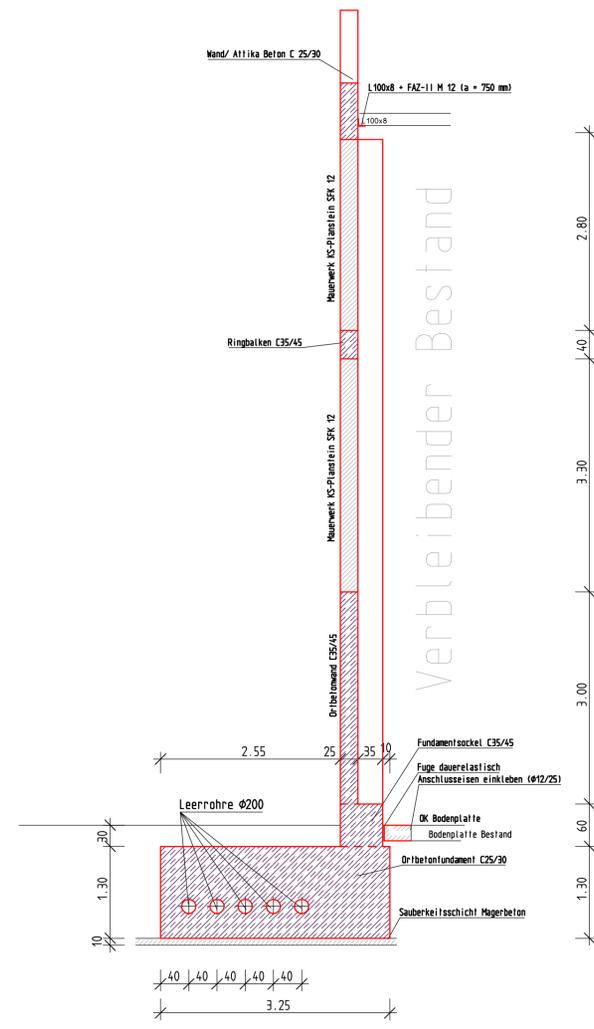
Gebäude 11 – Wand straßenseitig mit aussteifender Wand
